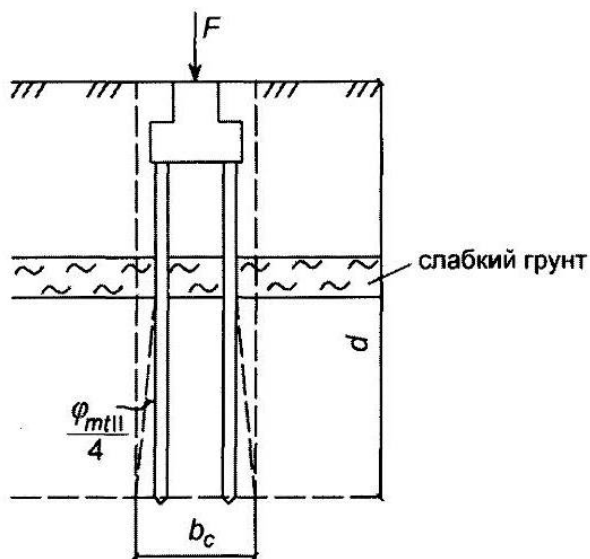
Схема визначення ширини умовного фундаменту для розрахунку його осідання
